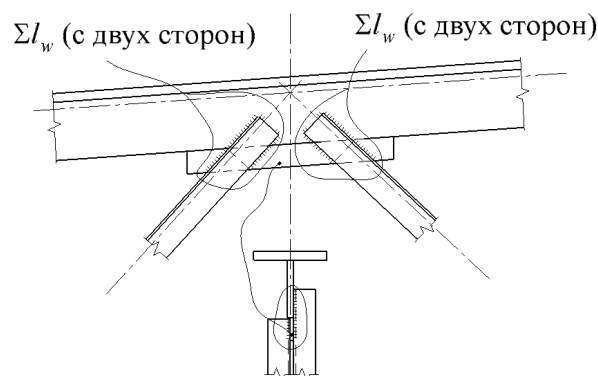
Узел примыкания раскосной решетки к верхнему поясу фермы из тавра с дополнительной фасонкой
